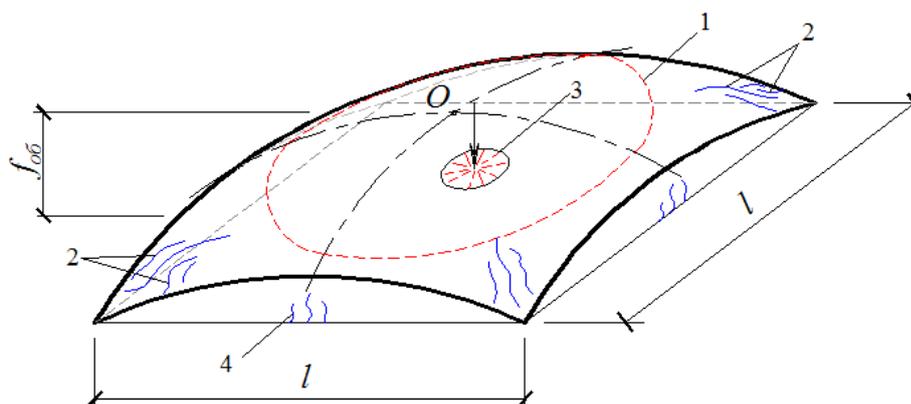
Трещины от нагрузки в железобетонной пологой оболочке двоякой кривизны:
